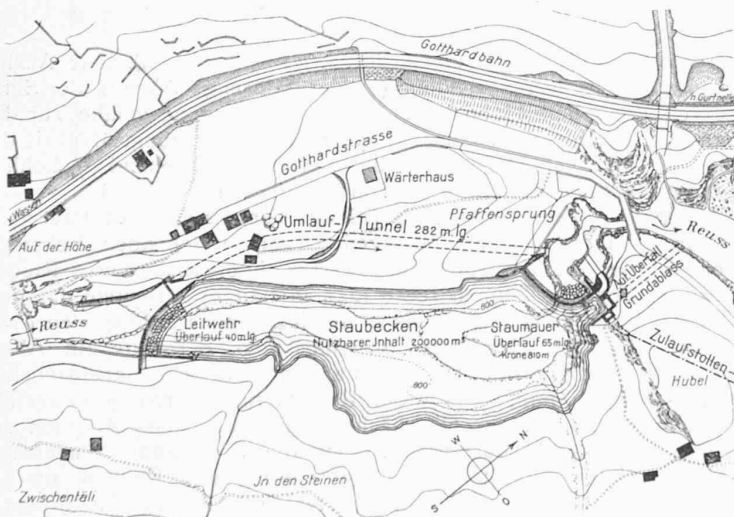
Umlauftunnel, Staubecken und Wasserfassung beim Pfaffensprung. — 1:5000.
